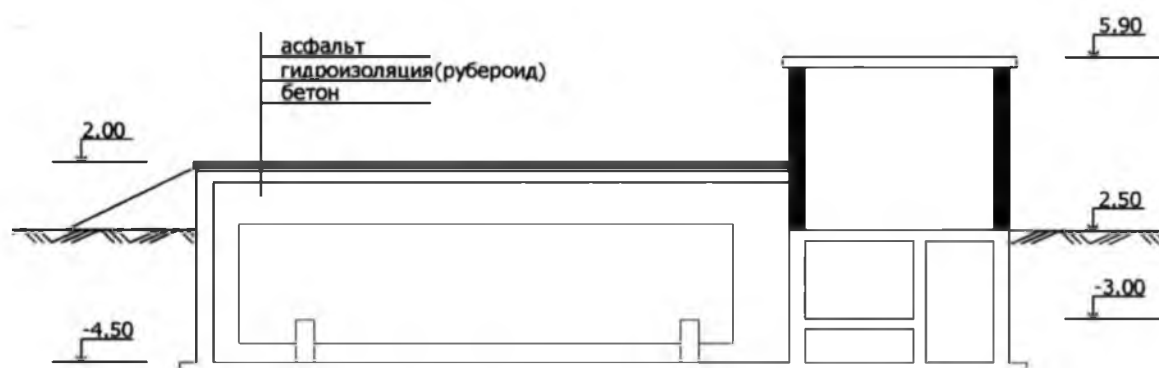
Вертикальный разрез хранилища жидких отходов (ХЖО № 1)
